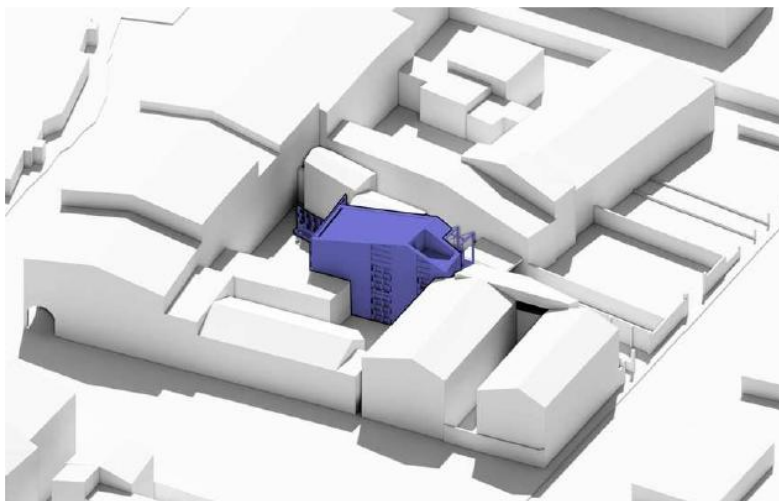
Inserimento 3D del nuovo intervento nel contesto. Vista da nord-est
